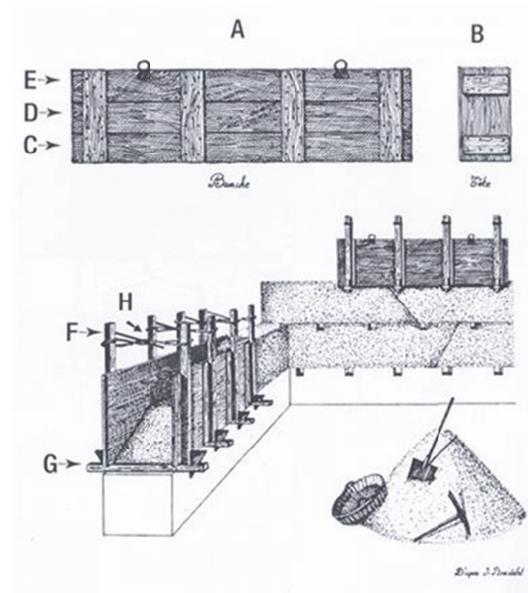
Técnica constructiva de la tapia según J. Rondelet, Fuente: Doat, Hays Houben y Votoux, "Construire en terre". Citado por López Elum, op. cit., p. 178.
